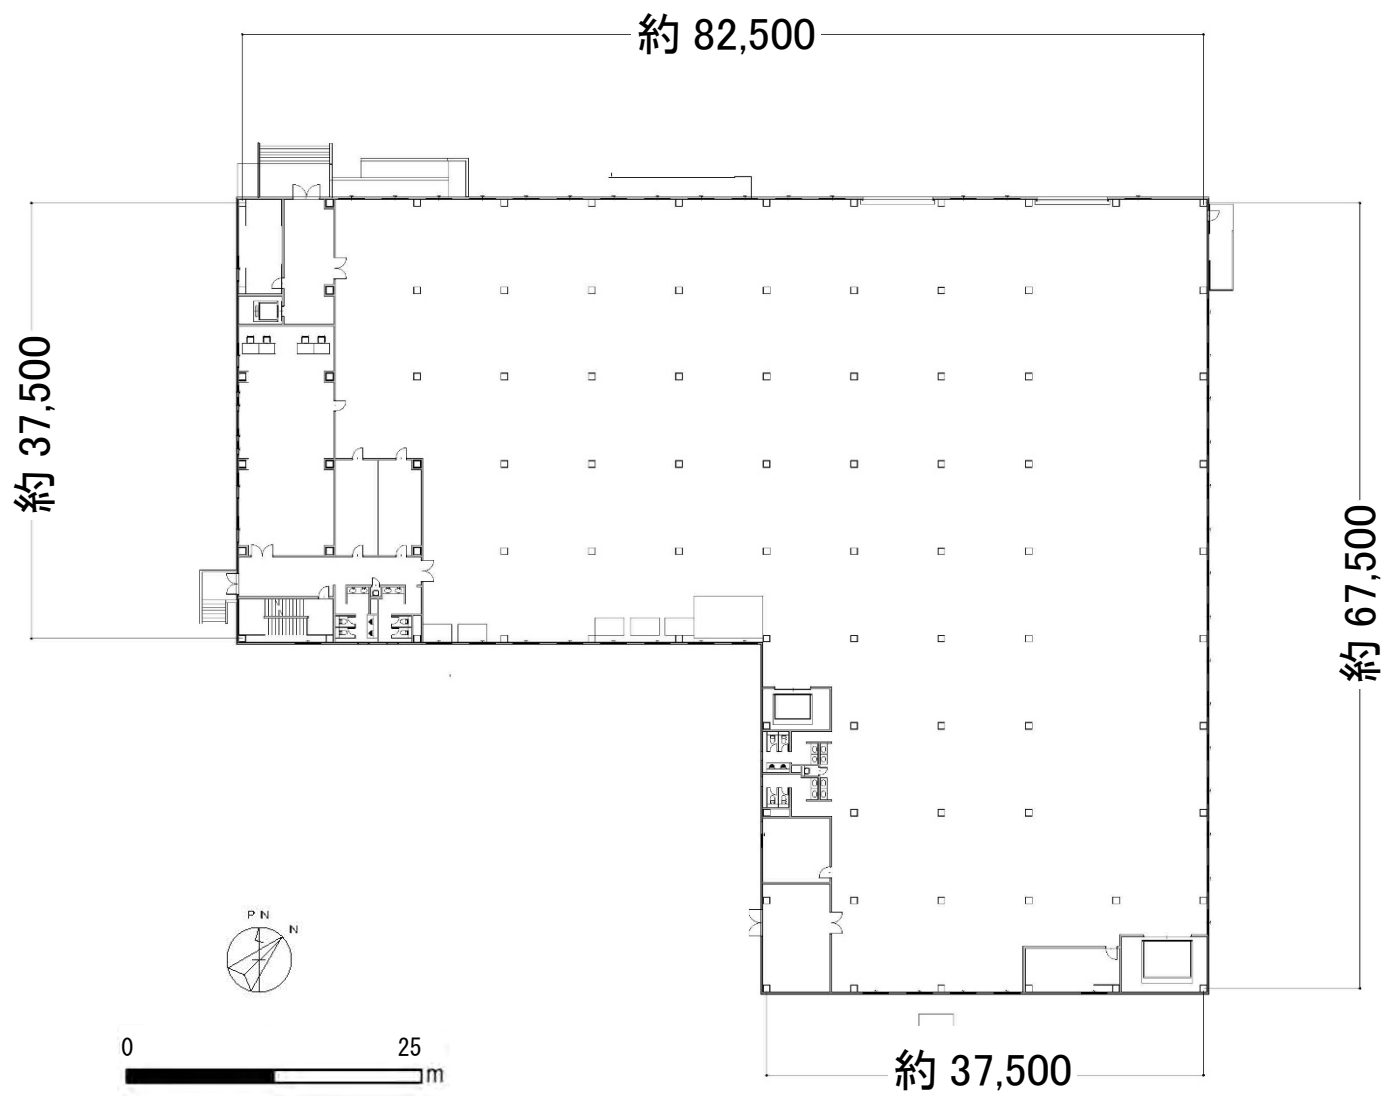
(1) 計画建物平面図(1階)：単位 mm
